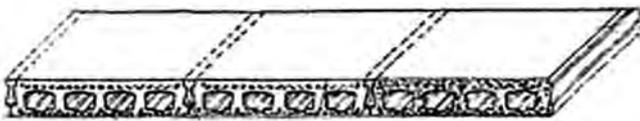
Поперечное сечение плит с 4 пустотами [10]
